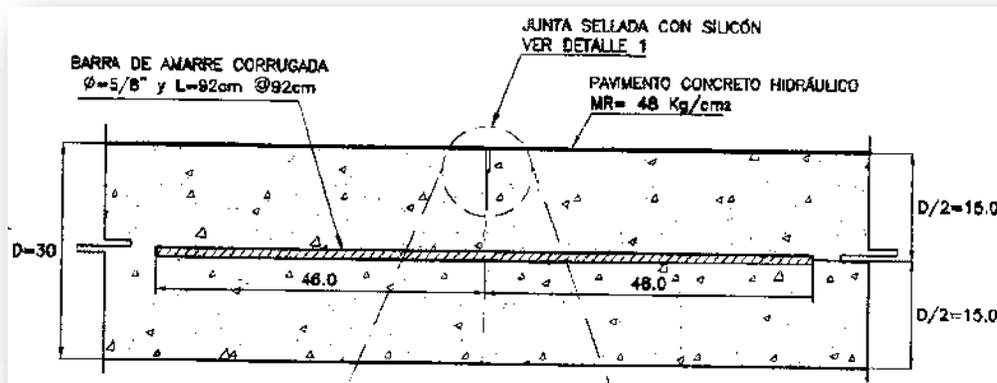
Junta de contracción longitudinal (varilla de amarre).Fuente (proyecto Ejecutivo)
